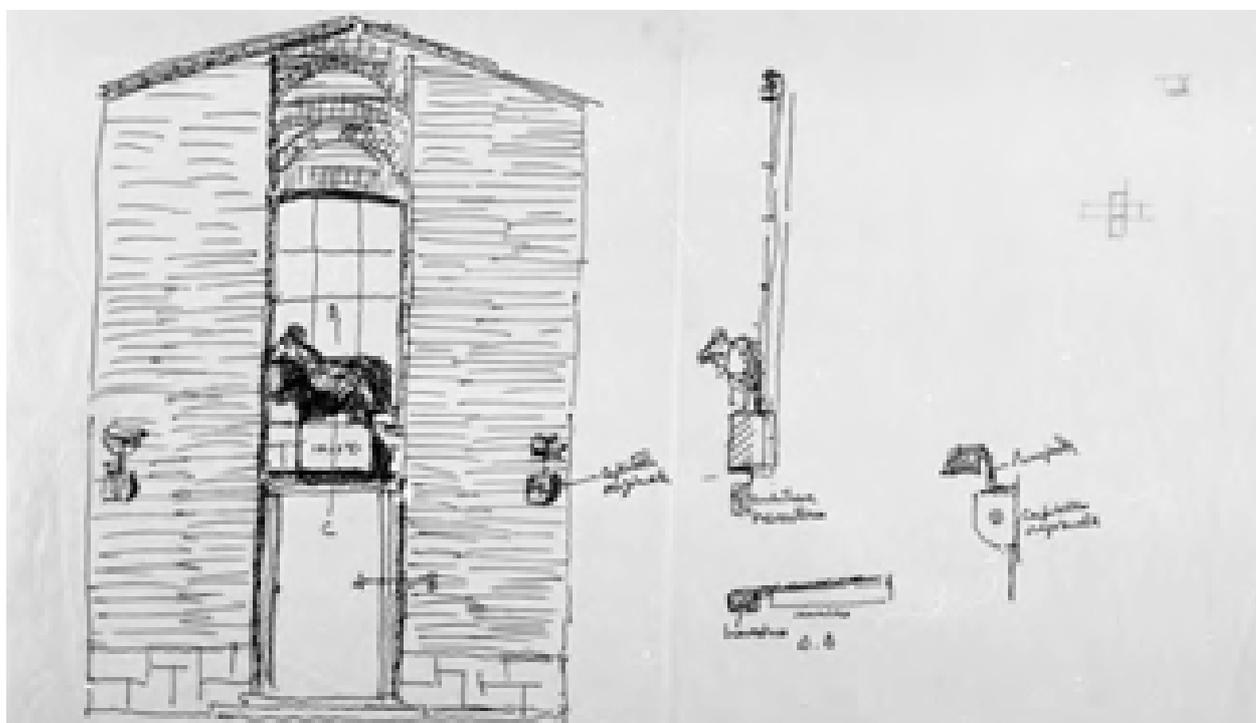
Prospetto - s.d. (AFMGF-1656)
